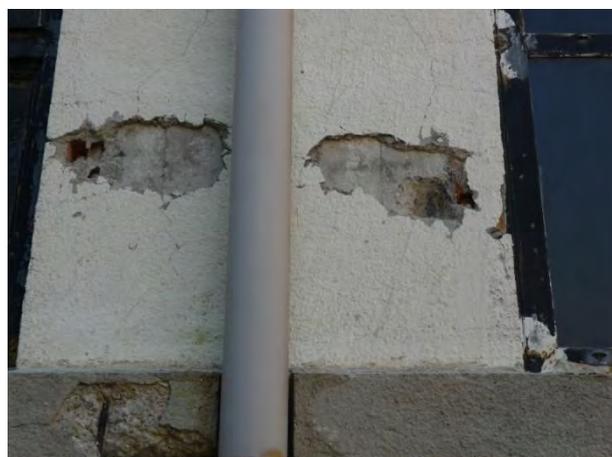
pilastro perimetrale della palestra, parzialmente rivestito in muratura
